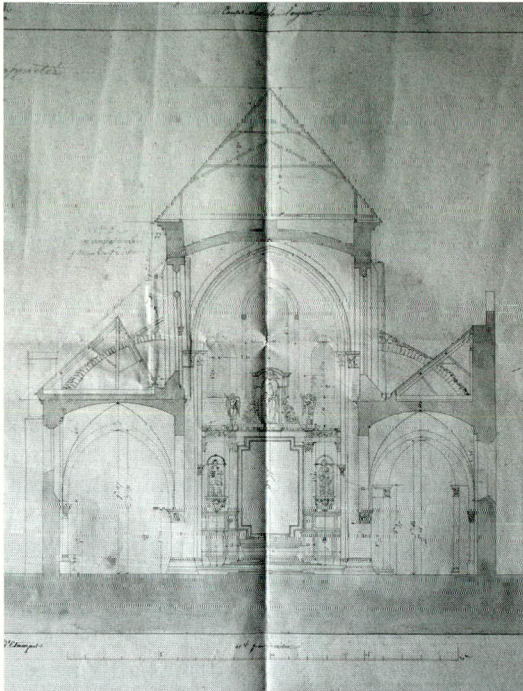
Étampes, Notre-Dame, coupe à travers la nef par Pierre Magne, ca. 1841 (Collection privée).
